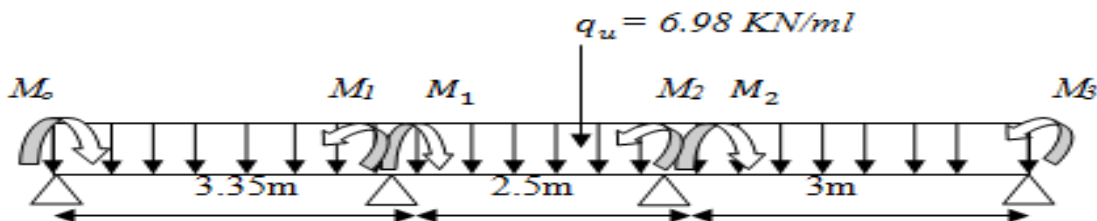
Schéma statique de la poutrelle type 1 E.L.U
